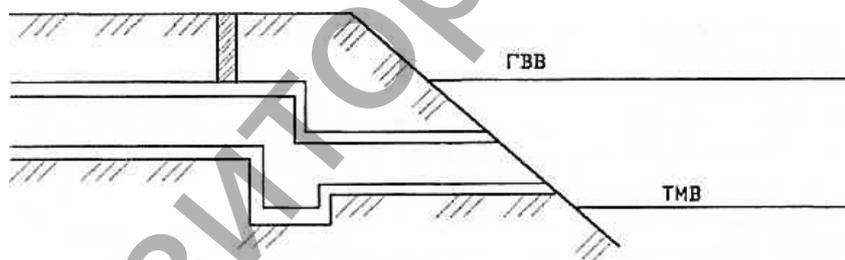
Выпуски водосточной сети (устраивают вне самой зоны, ниже по течению, незатопленными, на отметке нормального горизонта воды в реке)
